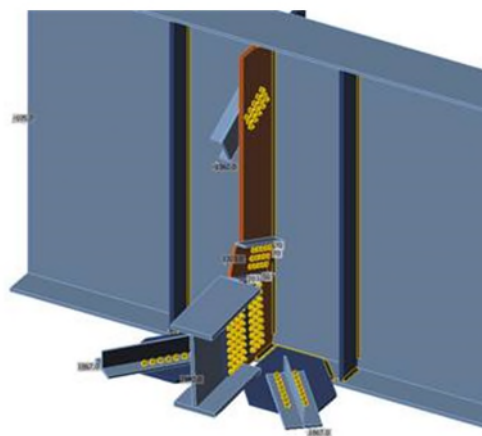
Vista de modelo de cálculo de unión típica entre diafragmas intermedios y vigas principales.
